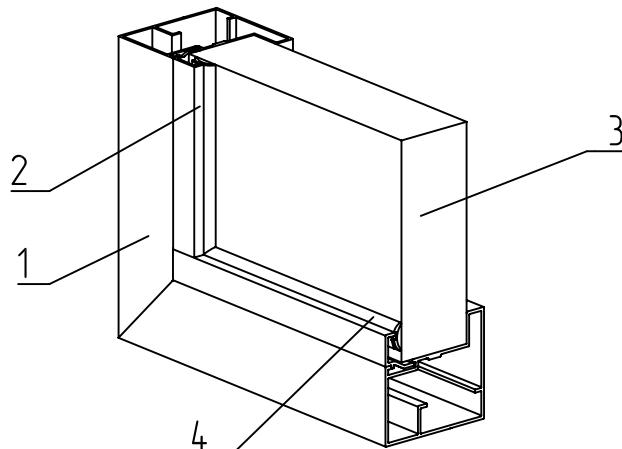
Установка штапика FLGU.400.0303 и уплотнителя FRK12 в створку калитки
